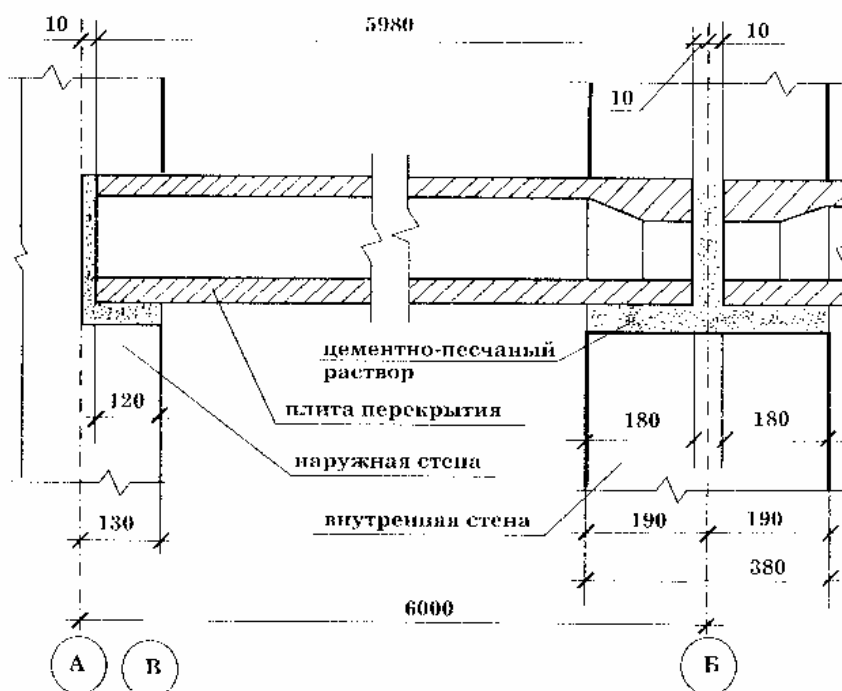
Привязка плит перекрытий к несущим стенам
